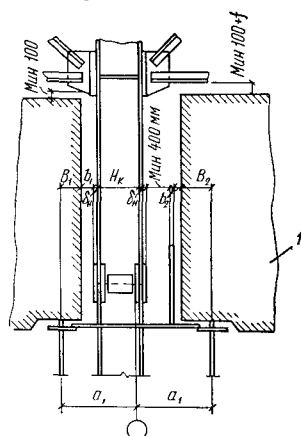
Основные размеры надкранового участка колонны при проходе вдоль подкрановых путей
